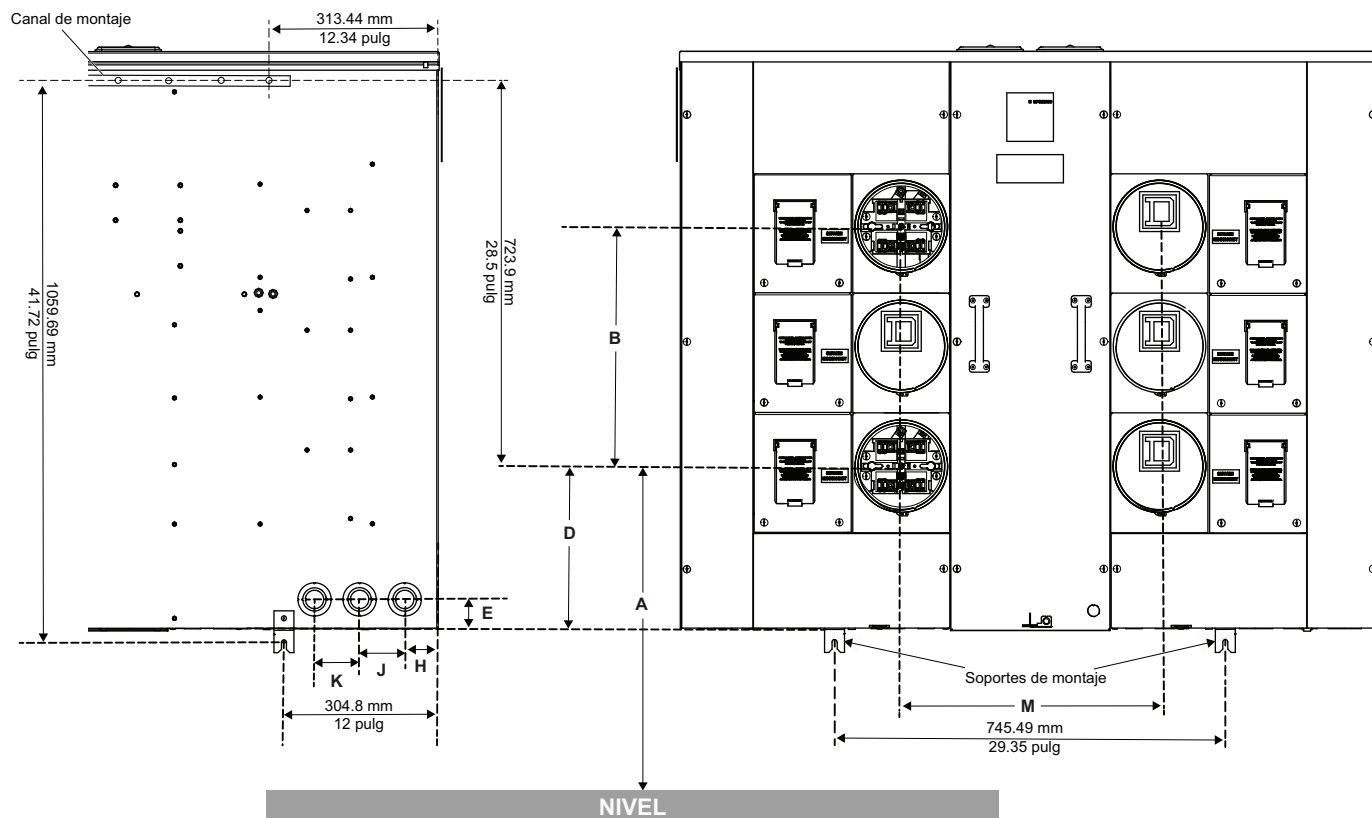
Dimensiones de montaje del producto de cuatro posiciones
